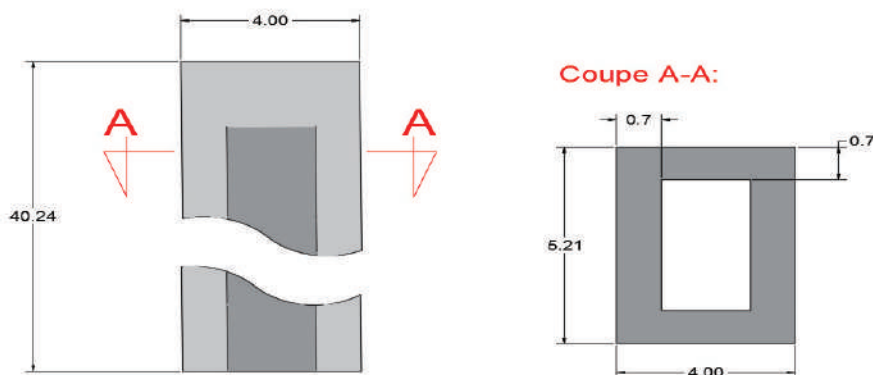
coupe longitudinale et transversale de la pile 02.
